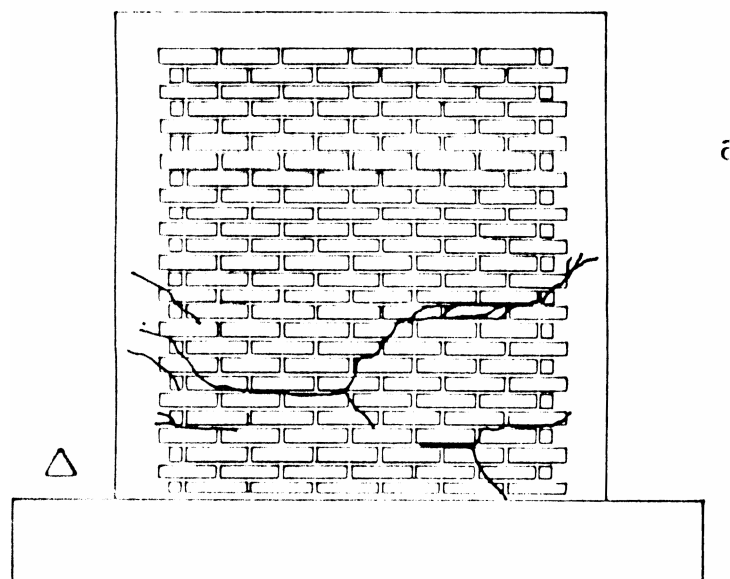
Estado agrietado de muro MRG1 (Diez, 1987)
